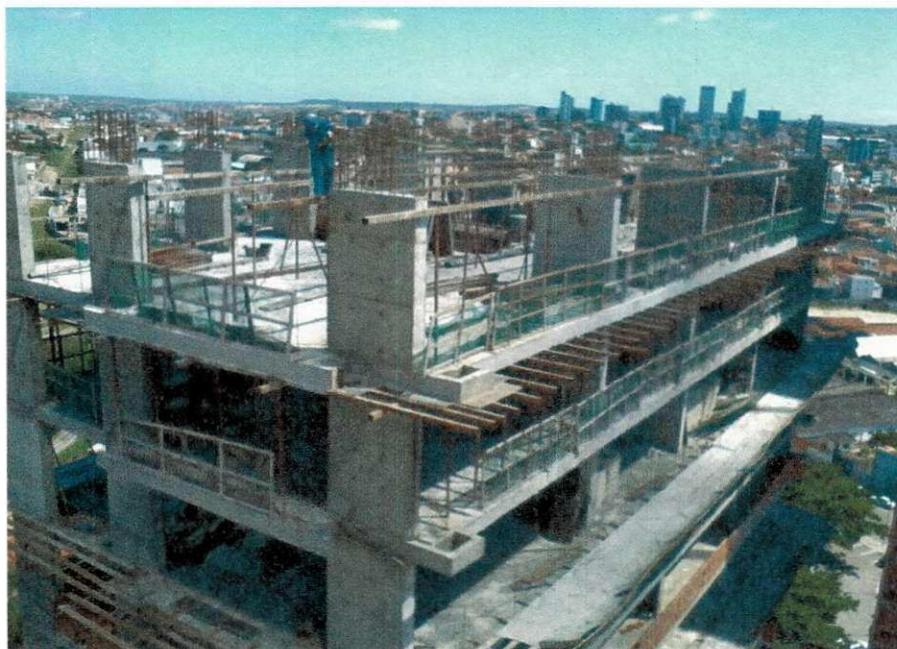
Montagem da laje do pavimento - tipo 15, Mundo Plaza (Bloco B).
